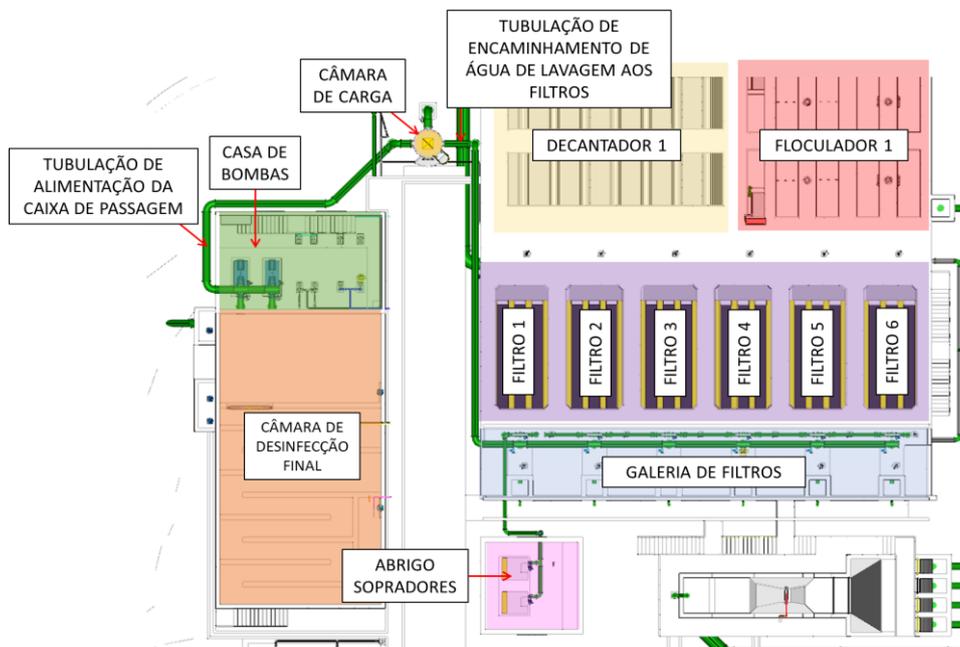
Esquema em planta da câmara de desinfecção final, da casa de bombas
